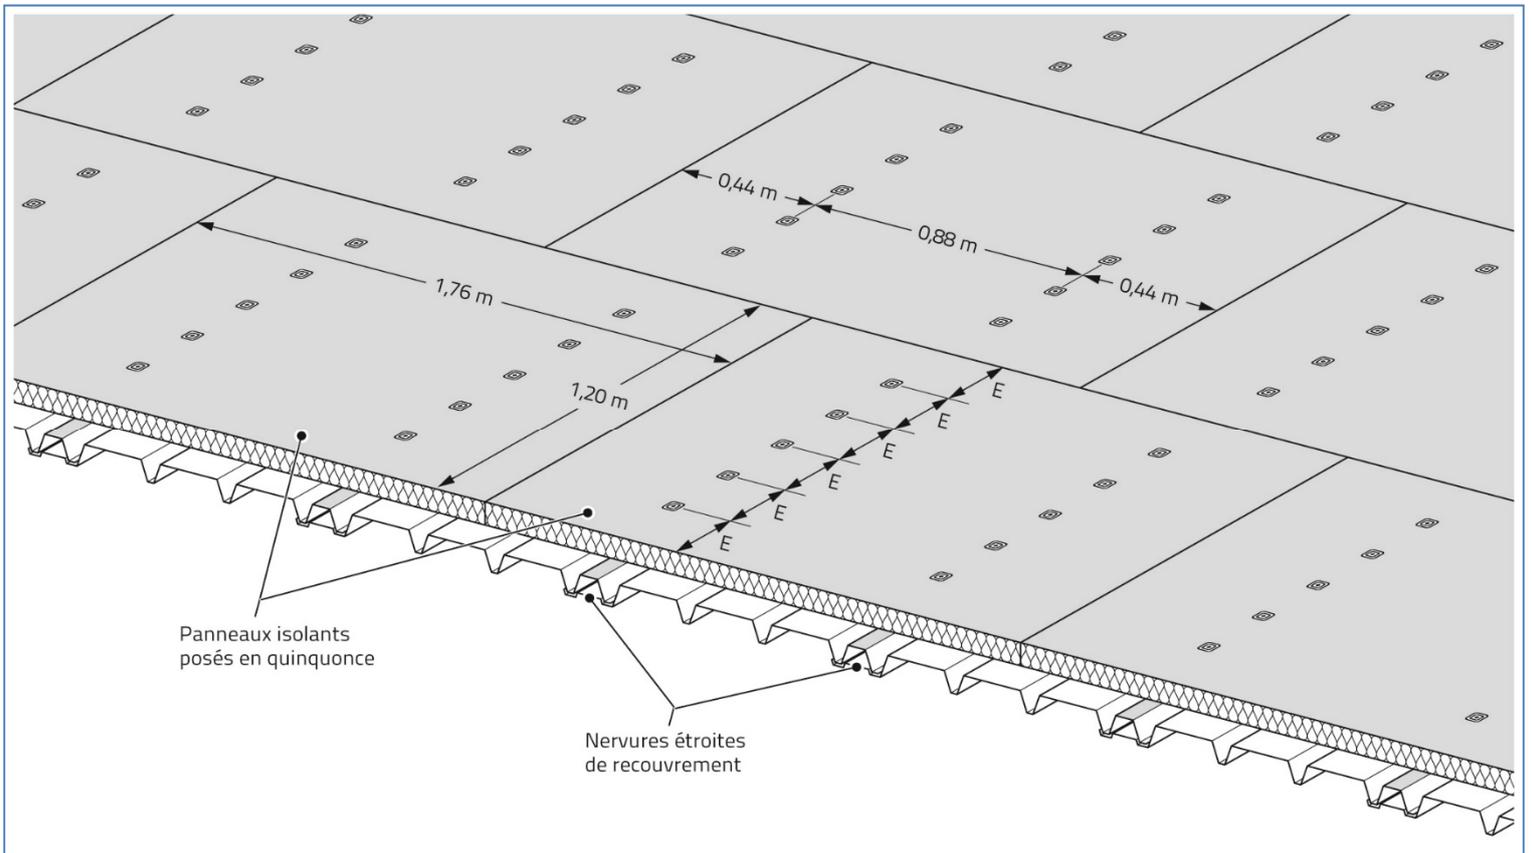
Fixations mécaniques des panneaux isolants de grandes dimensions (1,77 m x 1,2 m) sous revêtement d'étanchéité auto-adhésif
